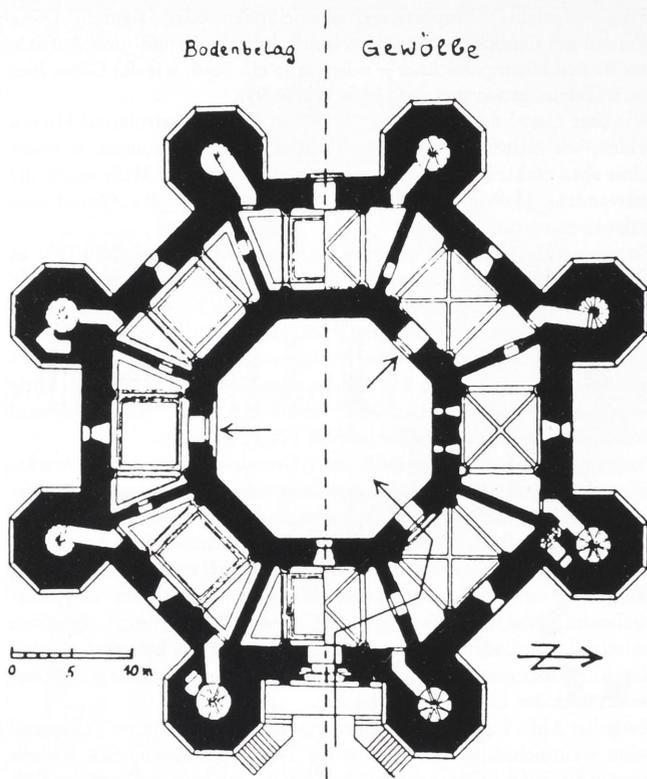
Castel del Monte, Grundriß nach H. Hahn, a.a.O., Abb. 32, Plan von Chierici mit Eintragungen Hahns (u.a. Nordpfeil).
